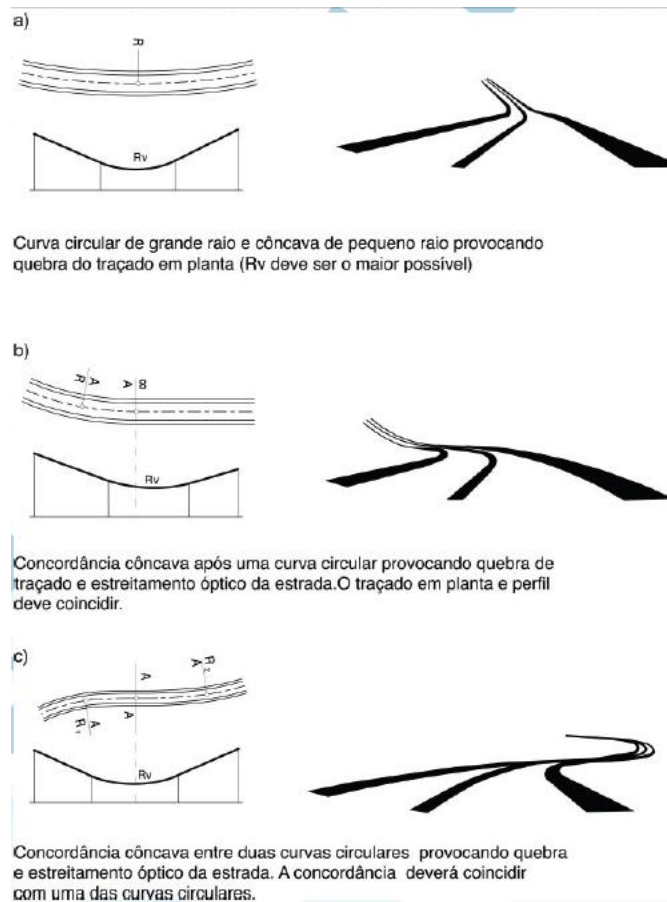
Coordenação do Traçado em Planta e Perfil 4 (Fonte: fig. 12D, [18] ou [19])
